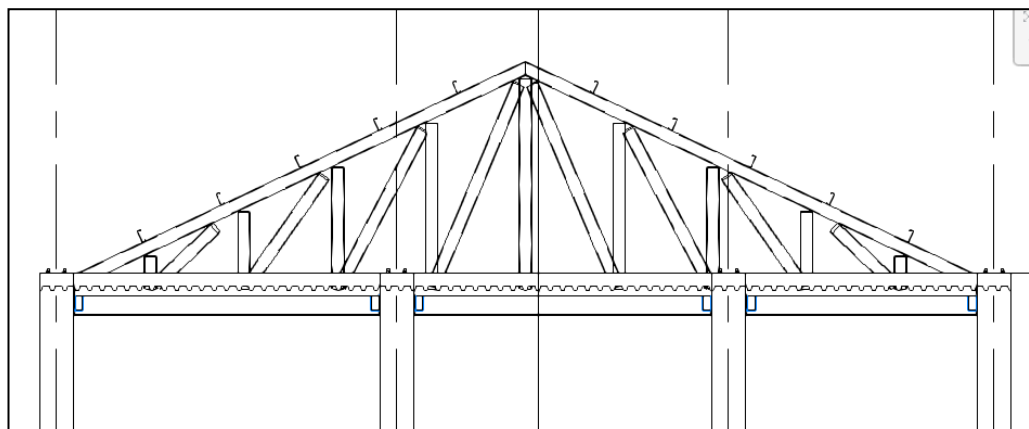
Vista de armazón estructural y correas utilizadas en la
